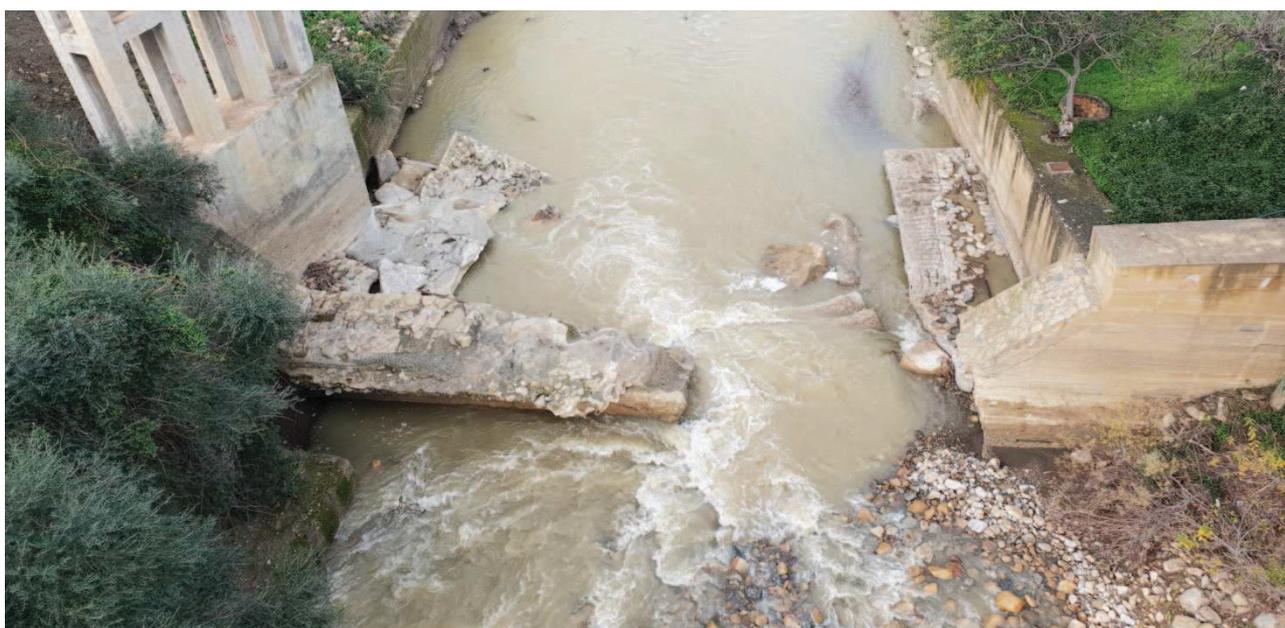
Stato di fatto - Alveo sotto il ponte al Km. 10+000 della S. P. 176
